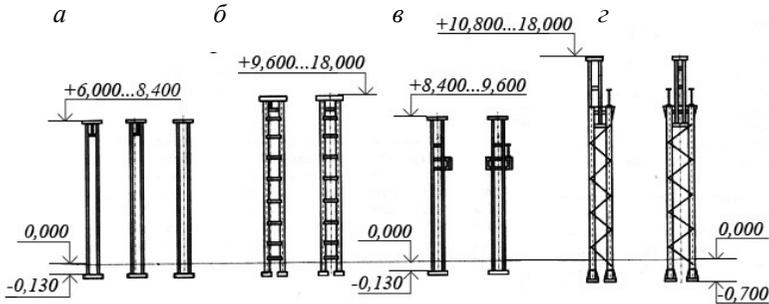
Типы стальных колонн: *а* — постоянного сплошного сечения для зданий без мостовых кранов; *б* — то же, двухветвевого сечения; *в* — сплошного сечения для зданий, оборудованных мостовыми кранами; *г* — то же, двухветвевого переменного сечения
